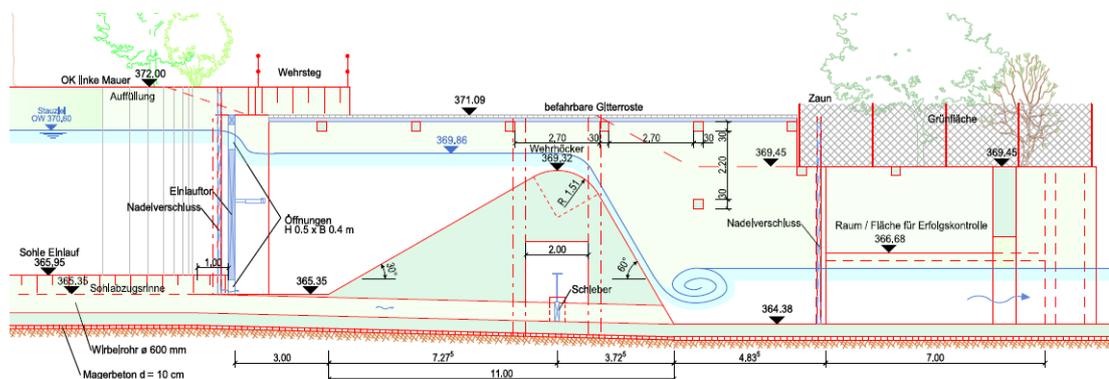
Schnitt durch den Bypass mit Einlaufftor und Wehrhöcker (Auszug Plan P.33N.044, IUB 2019)
